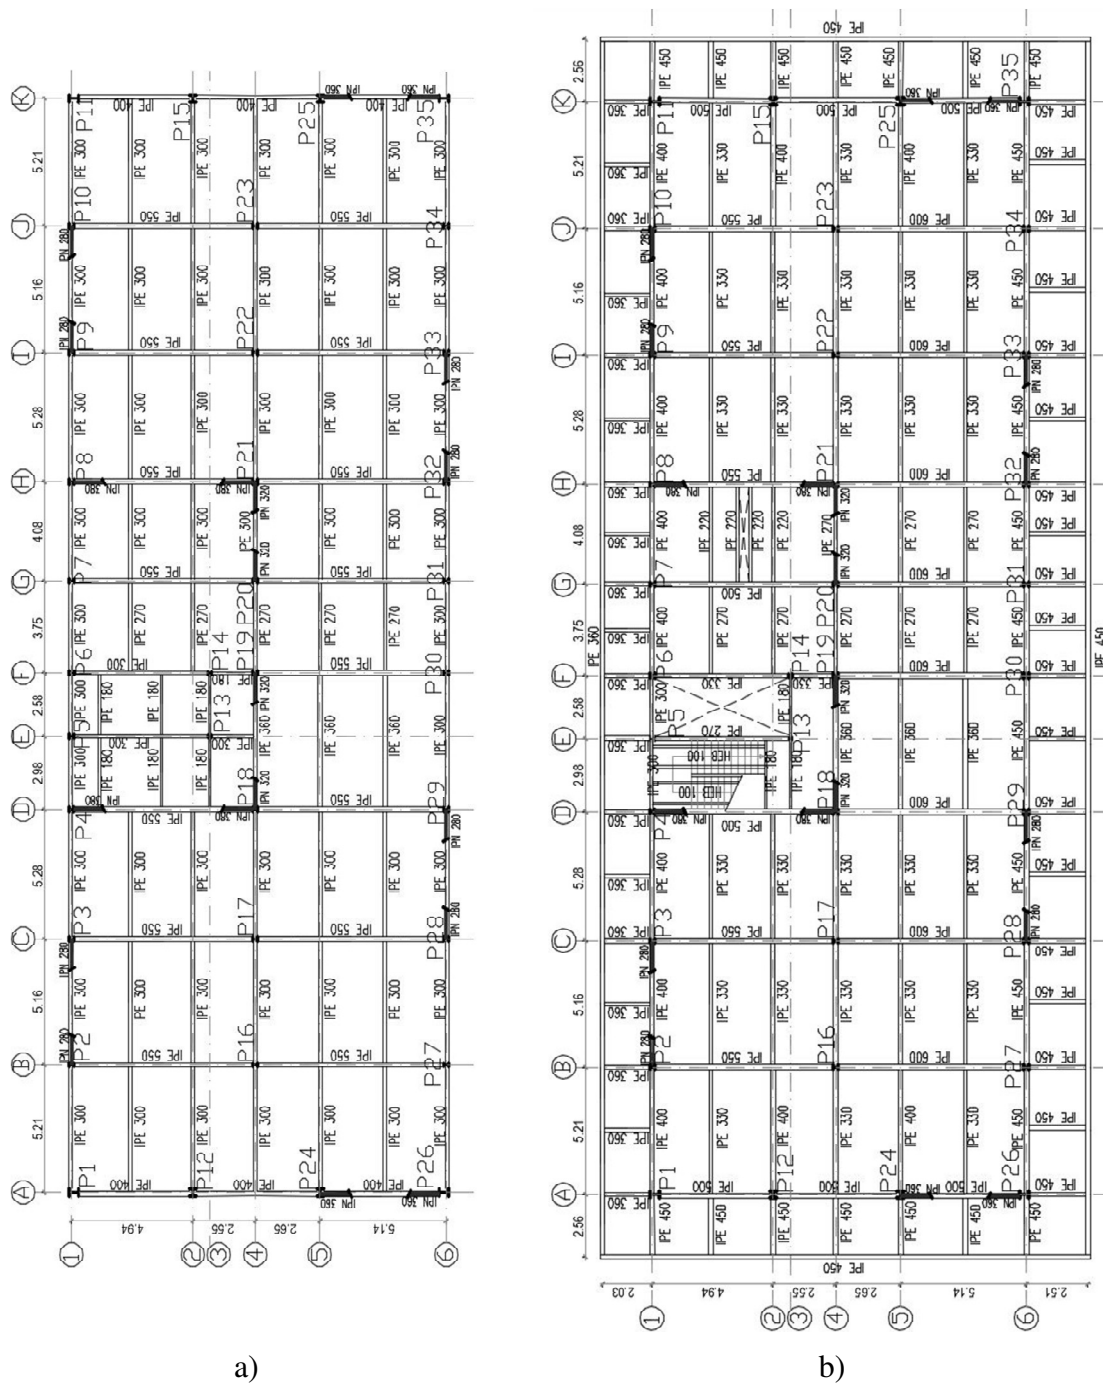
Plantas estruturais: a) cobertura; b) 6º piso
